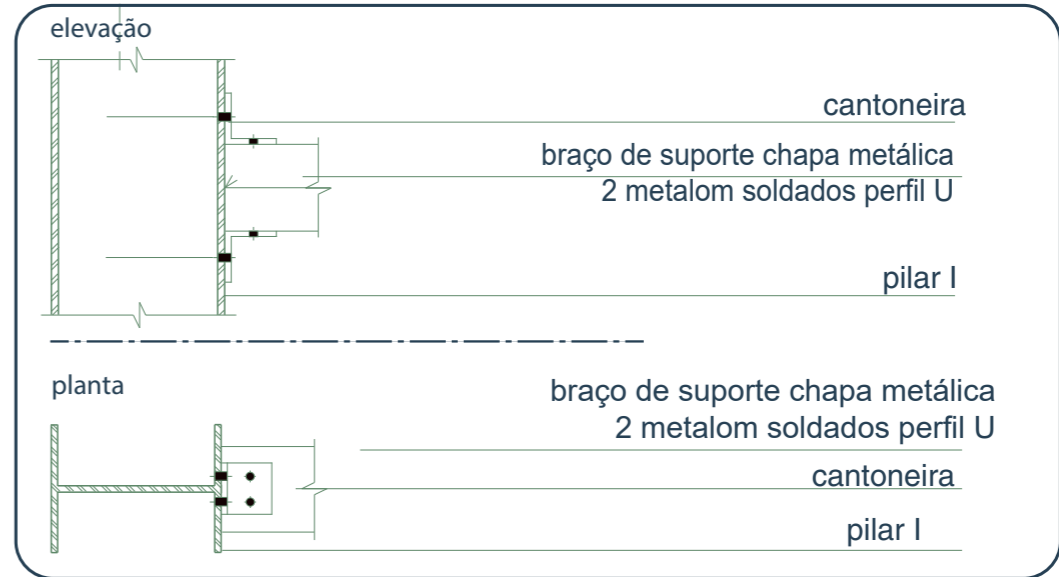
Detalhe do fechamento da fachada em malha de metálica.
